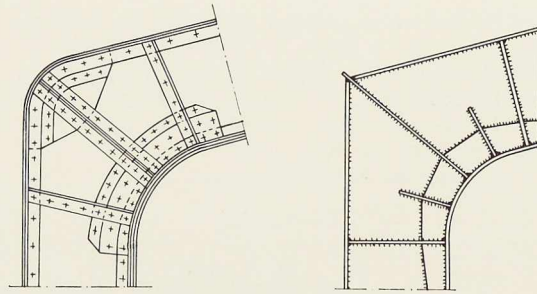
Nœuds de portiques rivé et soudé.
